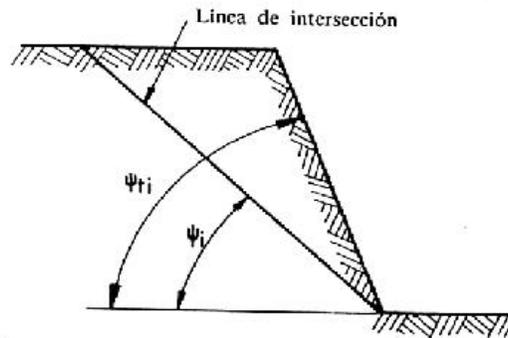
Ángulo de inclinación de la línea de intersección [7]
